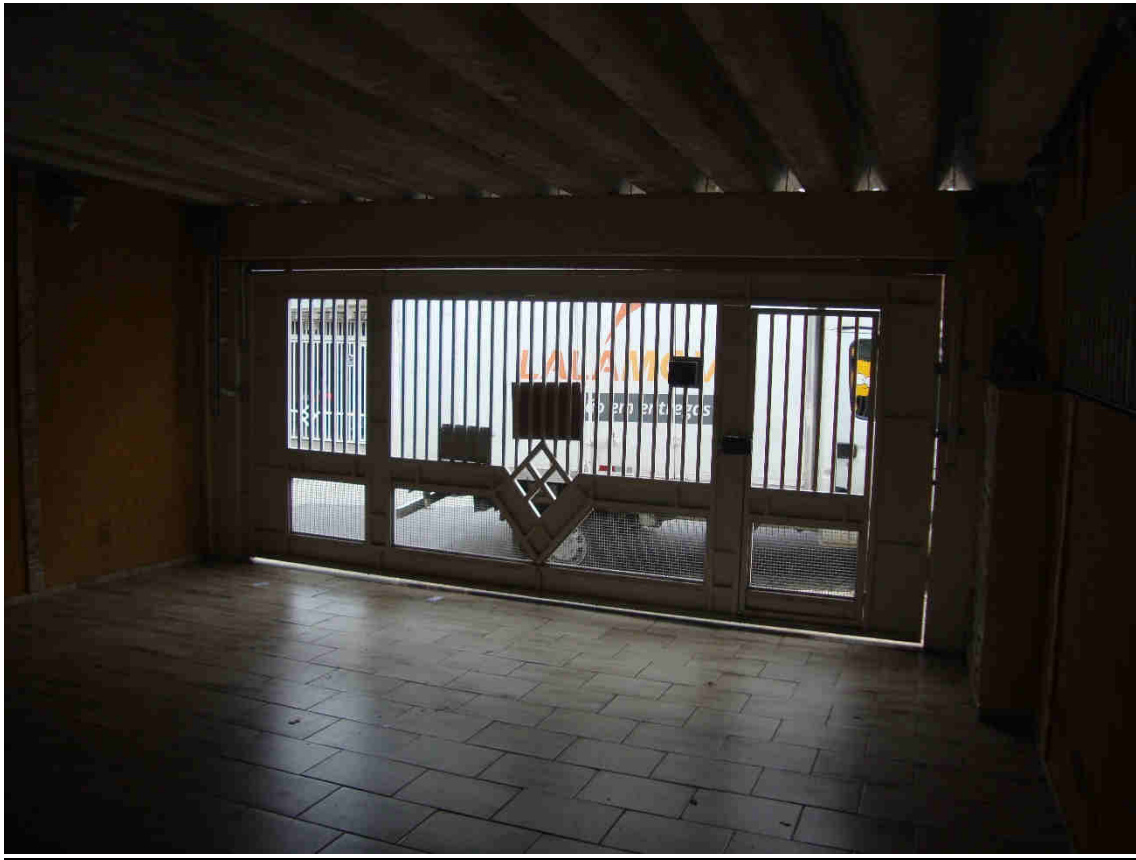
Aspectos da área de garagem (pavimento inferior).
